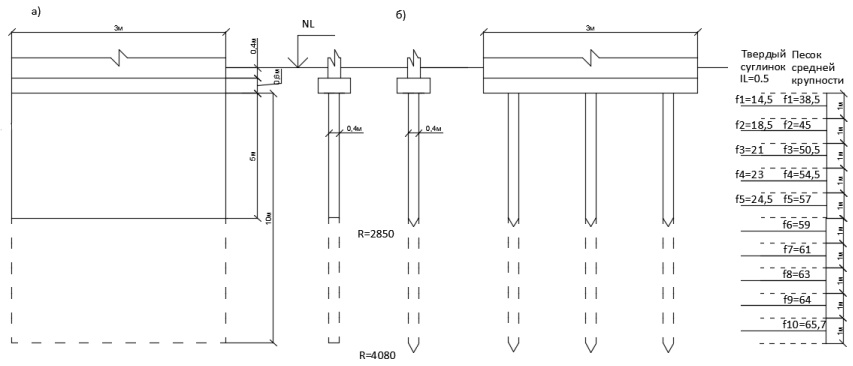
Схема к определению несущей способности фундаментов по грунту: а) щелевой фундамент; б) свайный фундамент.
